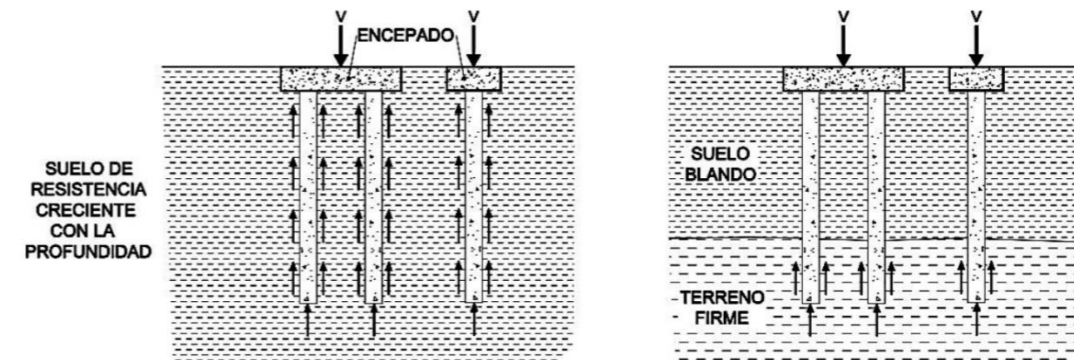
Izquierda croquis de cimentación mediante pilotes flotantes y derecha croquis de cimentación mediante pilotes columna. Fuente: Código Técnico de la Edificación.
